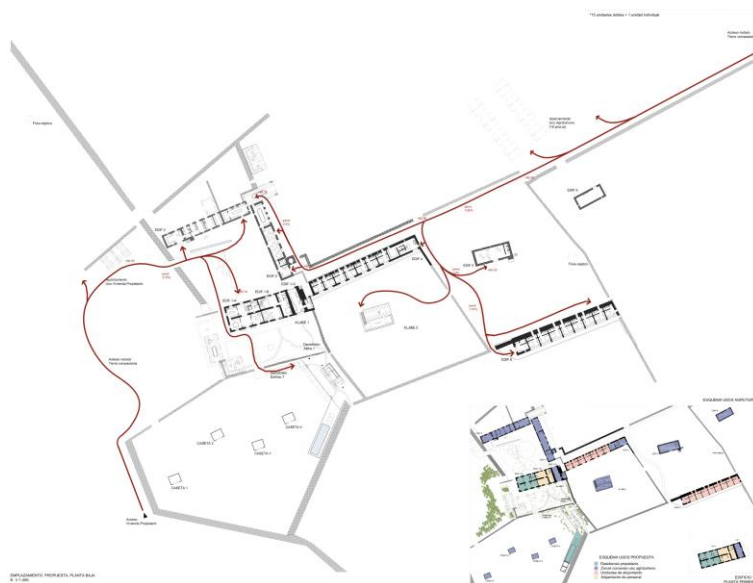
RED DE CAMINOS PROYECTADA (FUENTE: PROYECTO)
